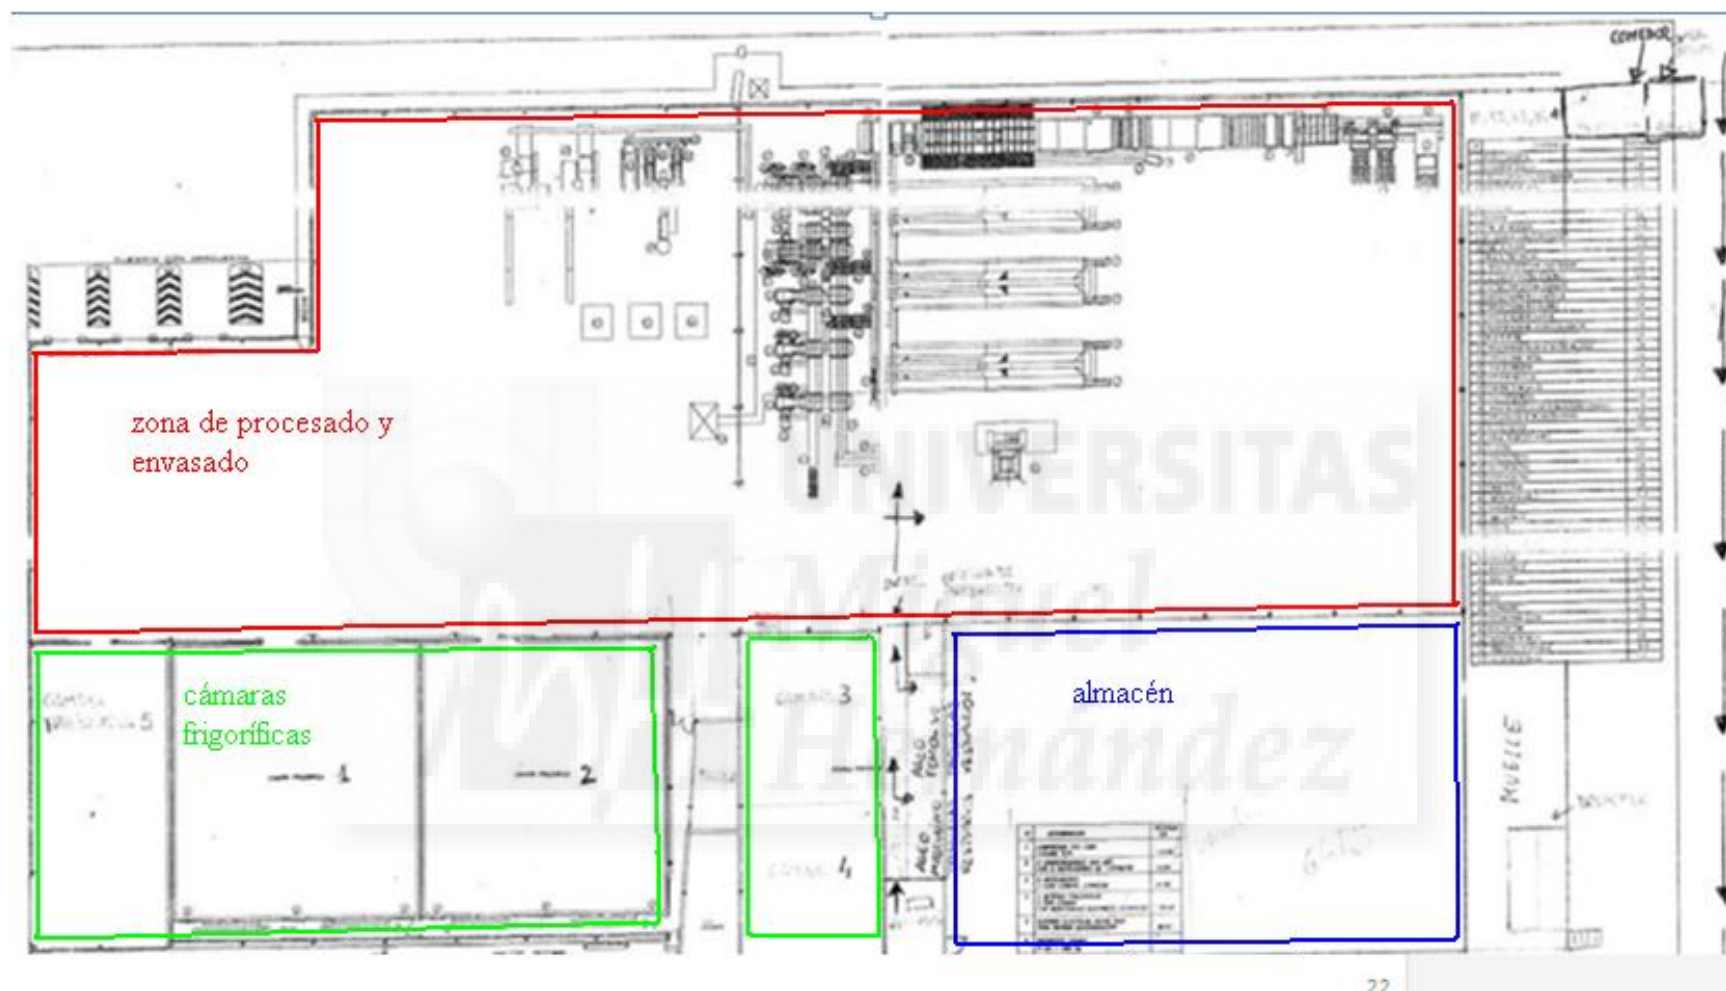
Plano de la distribución en planta de la industria (fuente: empresa).
